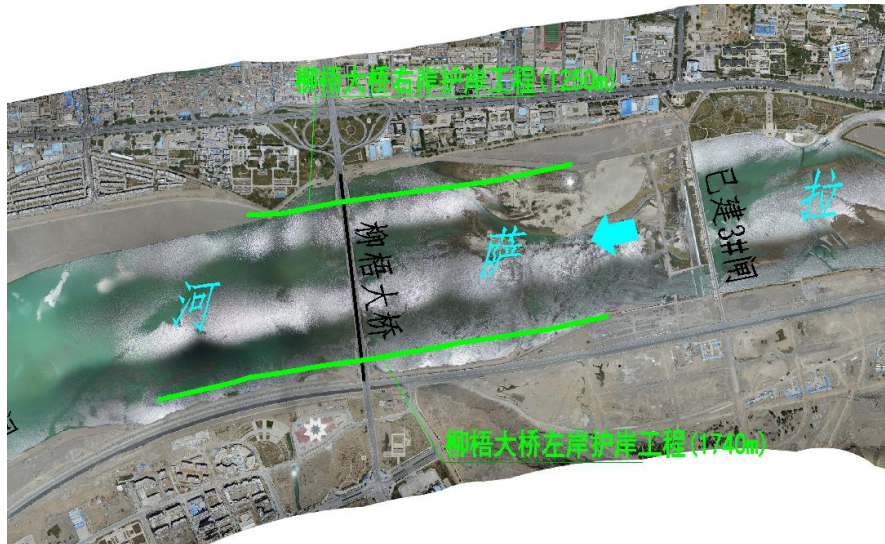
柳梧大桥左岸和右岸护岸工程平面布置示意图
